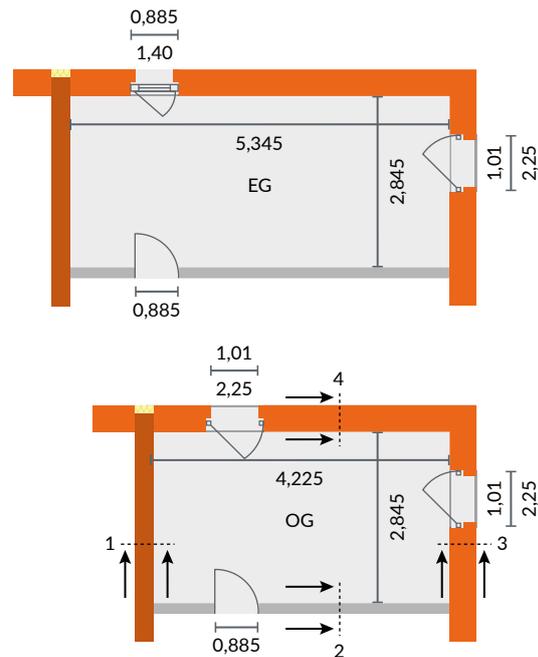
Grundrisse zweier übereinanderliegender Eckräume (Maßangaben in m)
